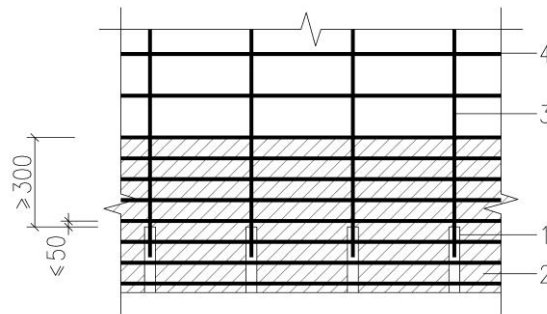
钢筋套筒灌浆连接部位水平分布钢筋的加密构造示意
